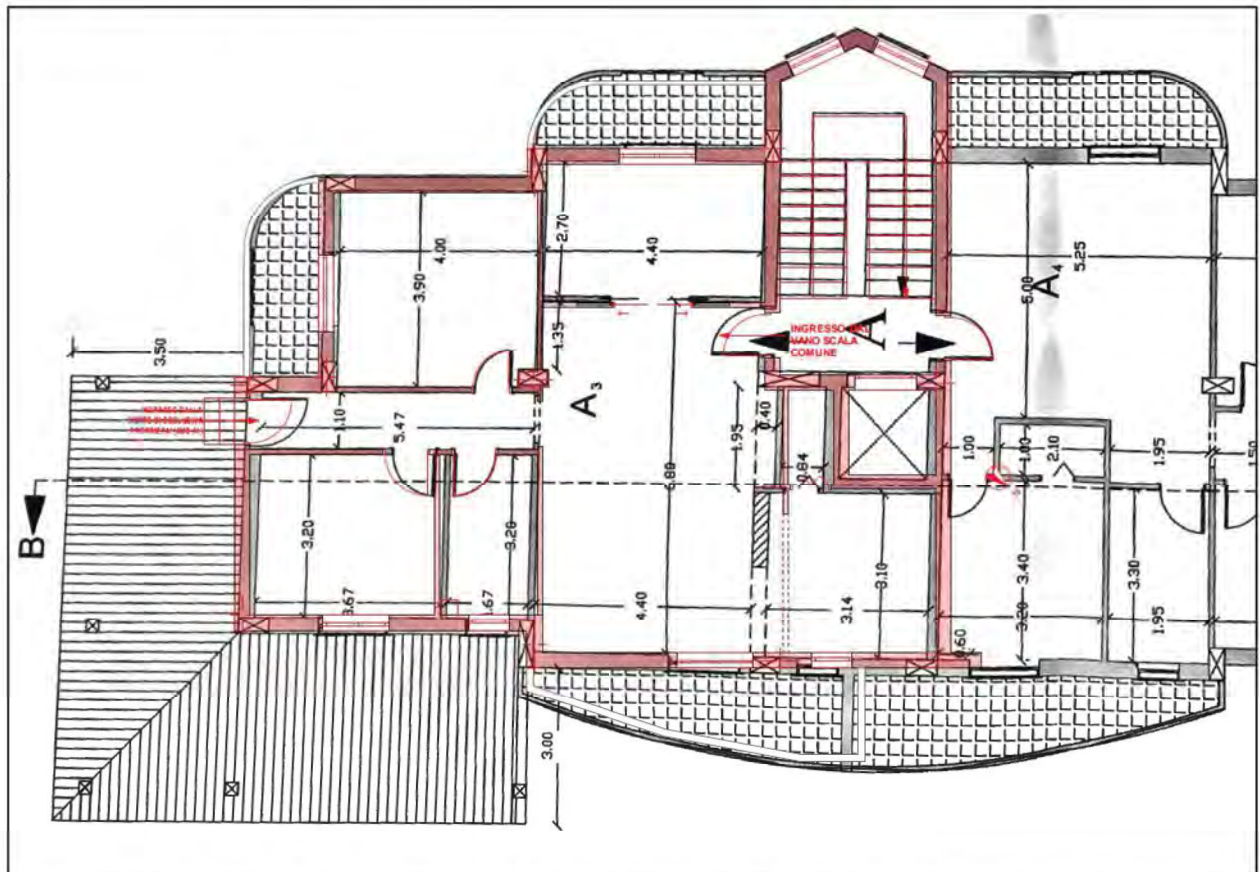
Pianta stato di fatto sovrapposta alla pianta del piano primo del progetto approvato con permesso di costruire in variante n.59 del 22/07/2008.
